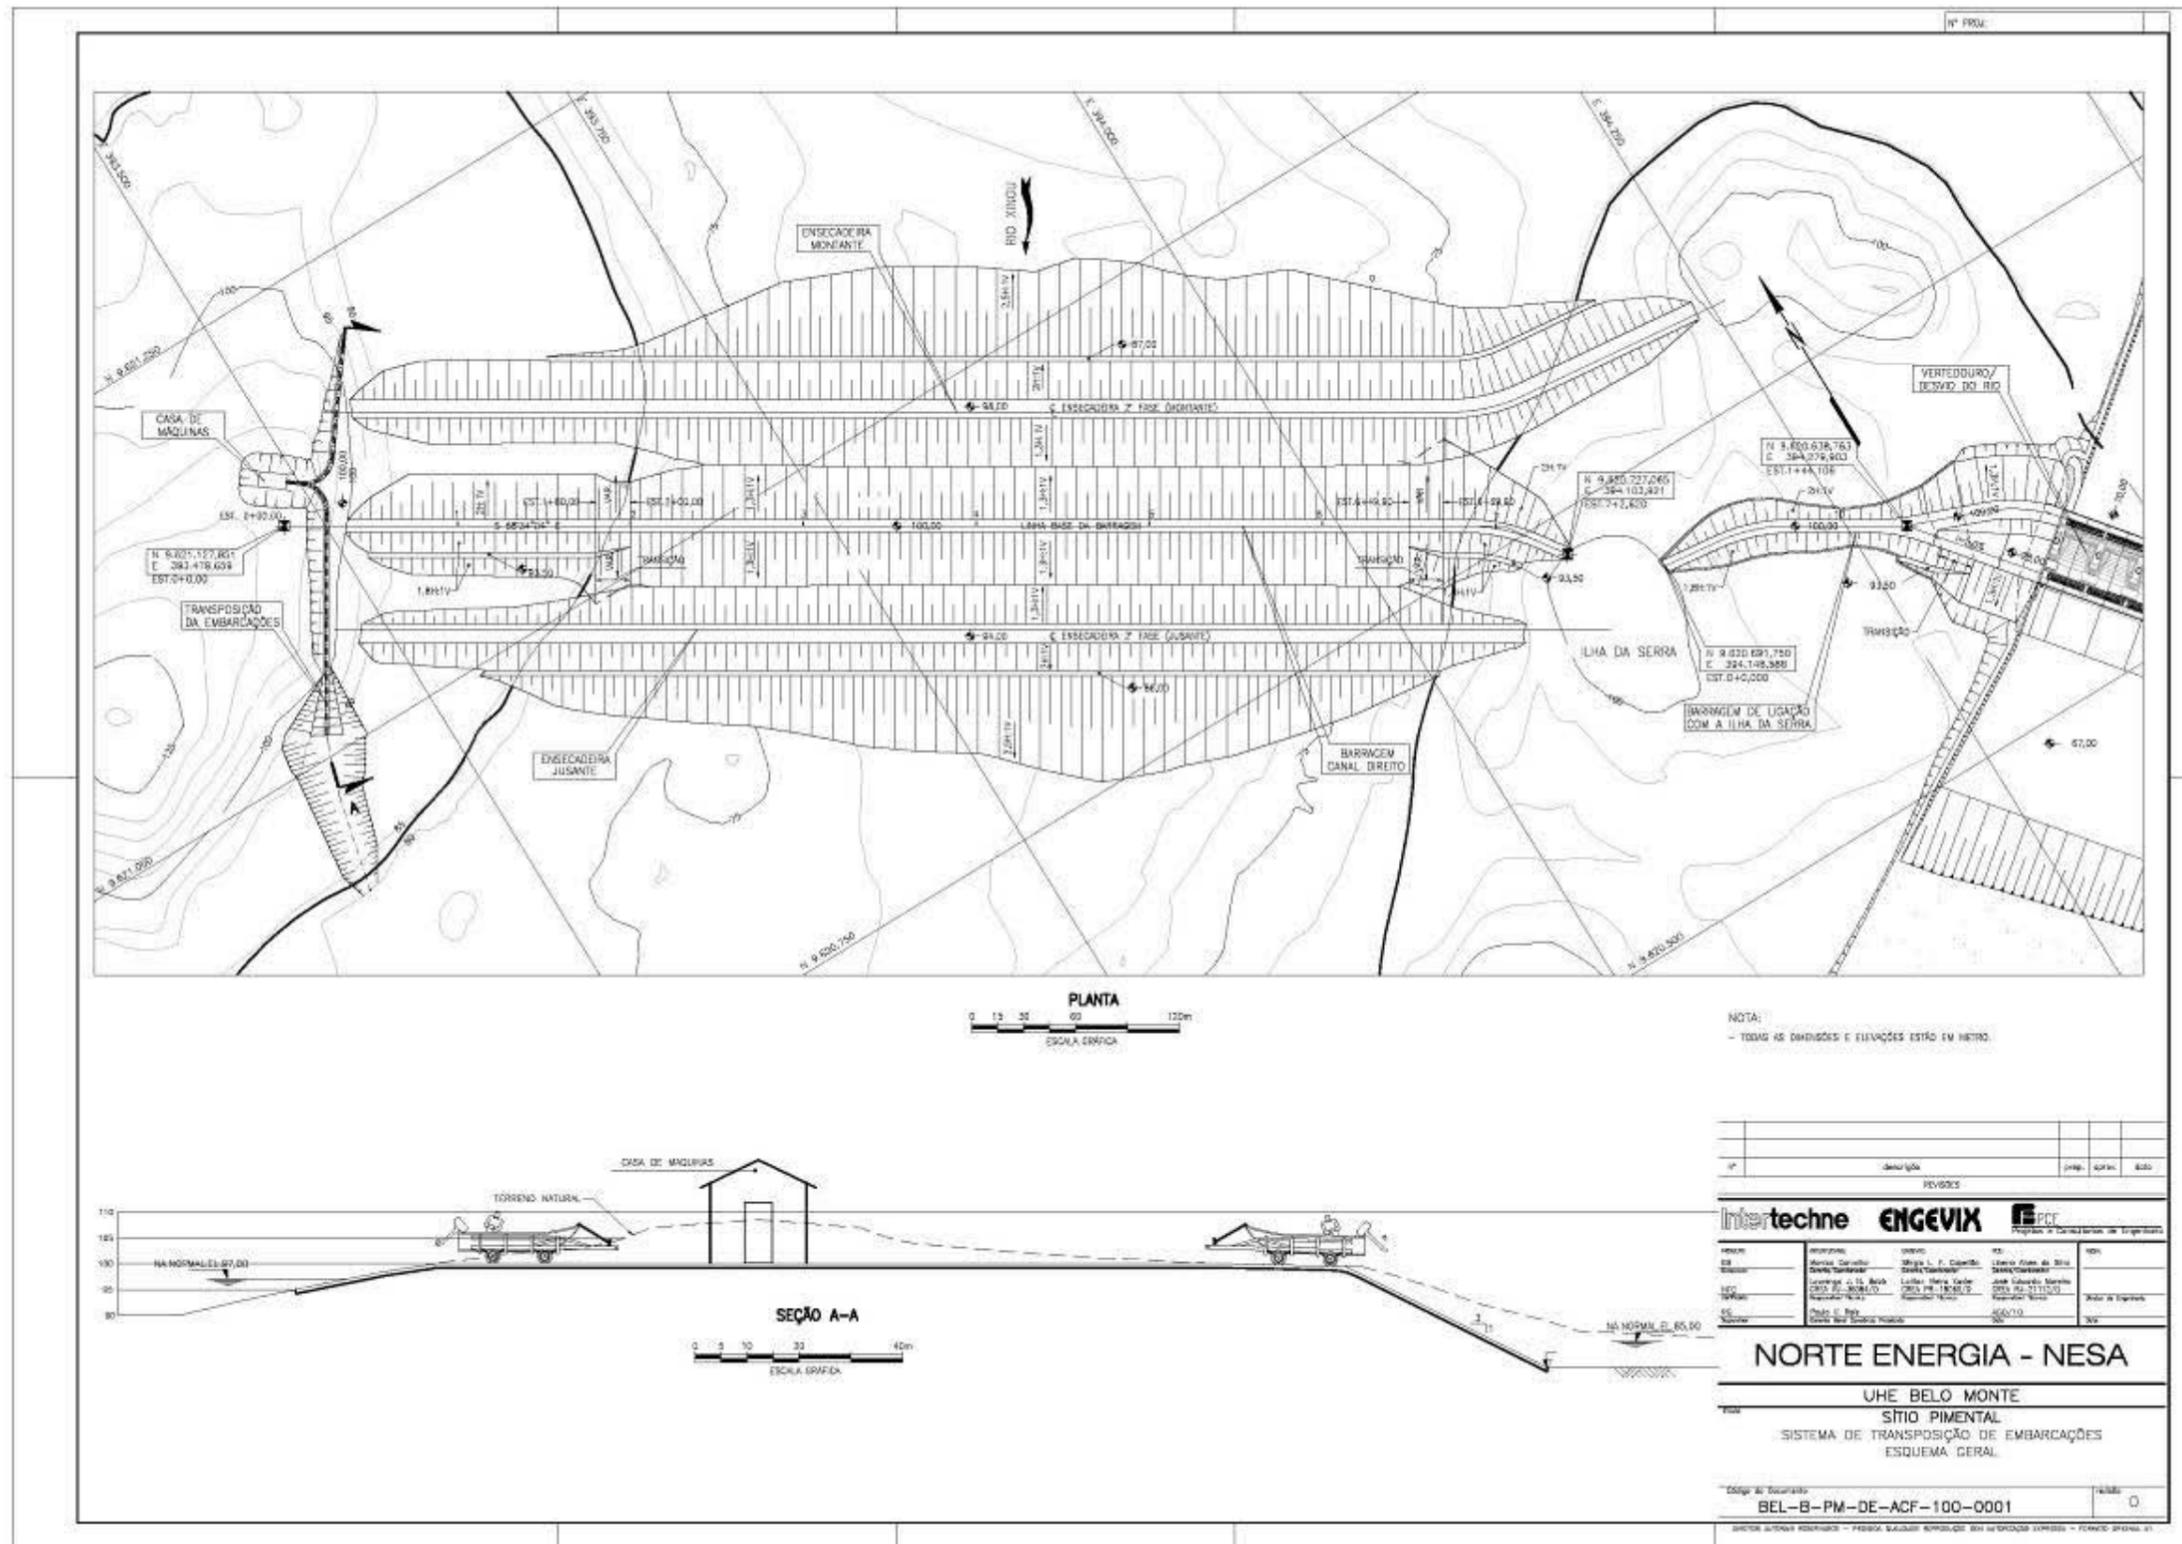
Desenho BEL-B-PM-DE-ACF-100-0001 R0 – Sistema de transposição de embarcações
